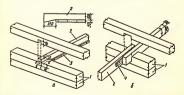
Схемы сопряжения балок перекрытия с брусьями наружной (a) и внутренией (б) стен: 1—брус; 2—балка; 3—черепной брусок; 4—металлическая пластина
